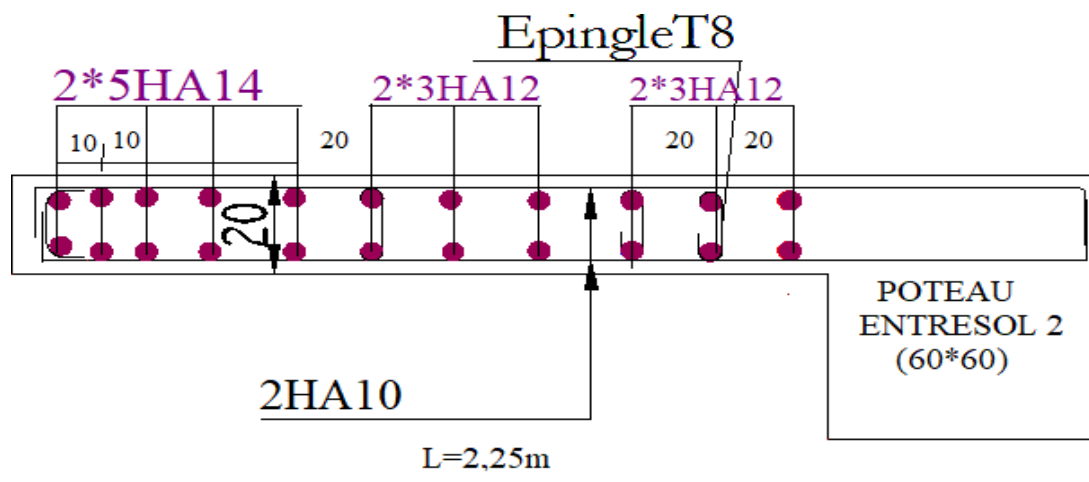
Schéma de ferrailage du voile VX2 au niveau d'entresol 2
